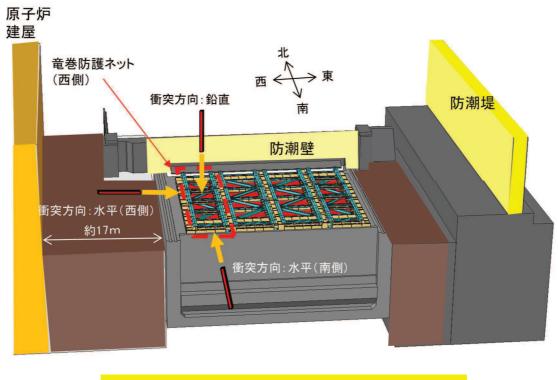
竜巻防護ネットの配置図(平面図・俯瞰図)
